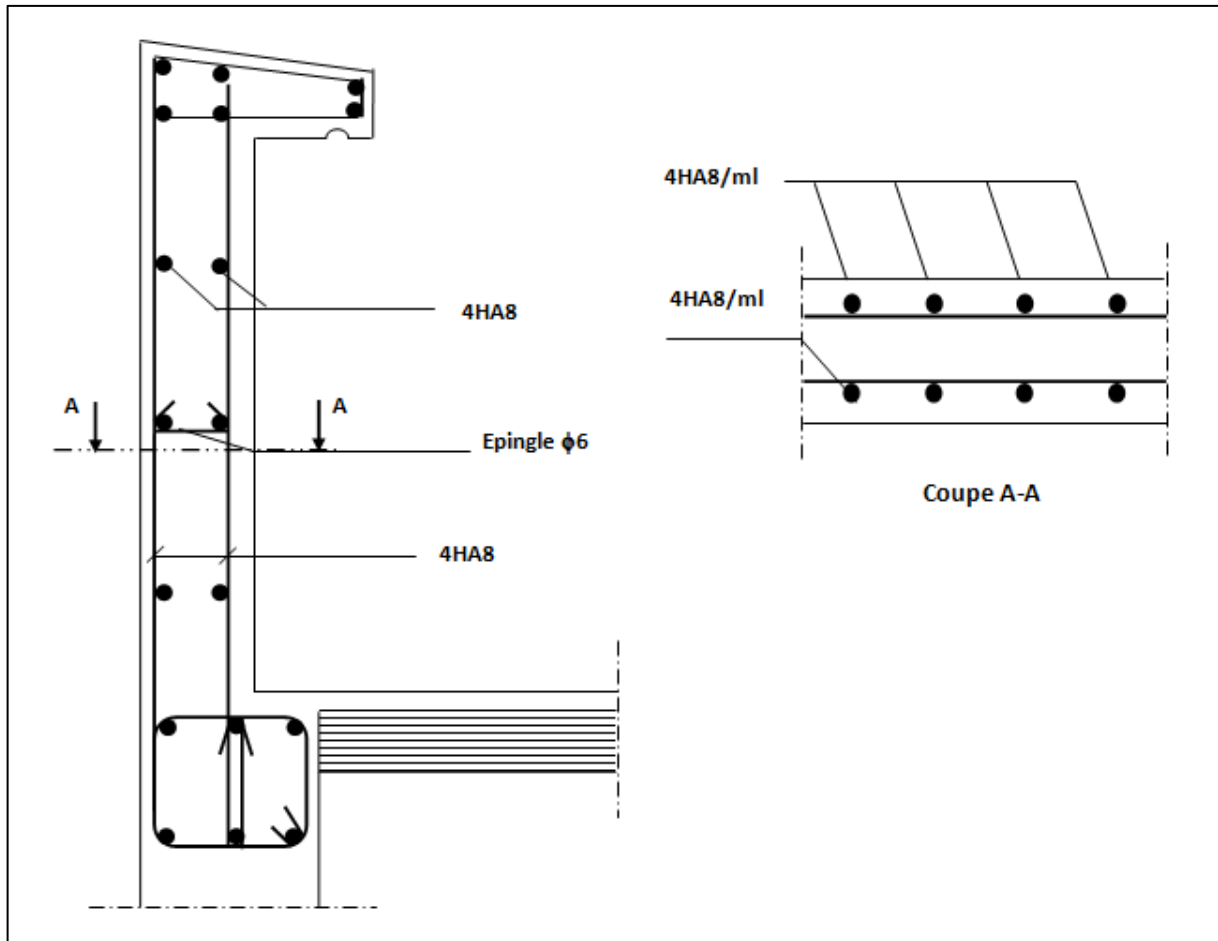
SCHEMA DE FERRAILAGE DE L'ACROTERE
